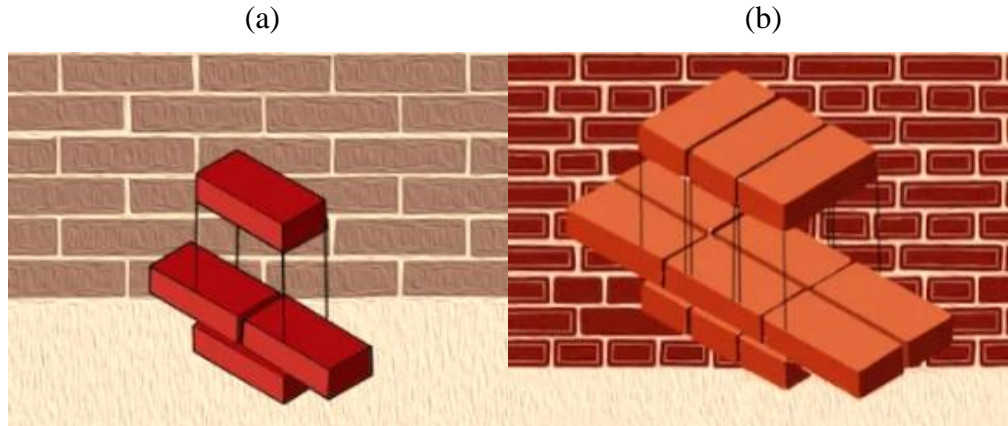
1 Disposición ladrillo: (a) aparejo sogá, (b) aparejo inglés ([www.gimsblog.com](http://www.gimsblog.com)).
